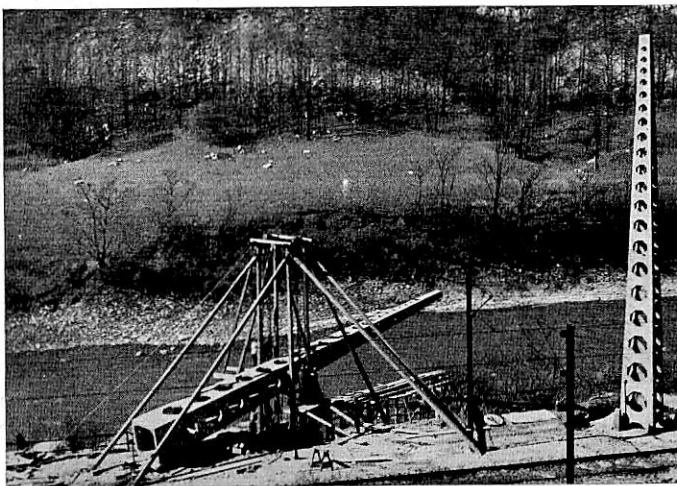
Eisenbetonmast. Aufstellung mit Stellgerüst.
